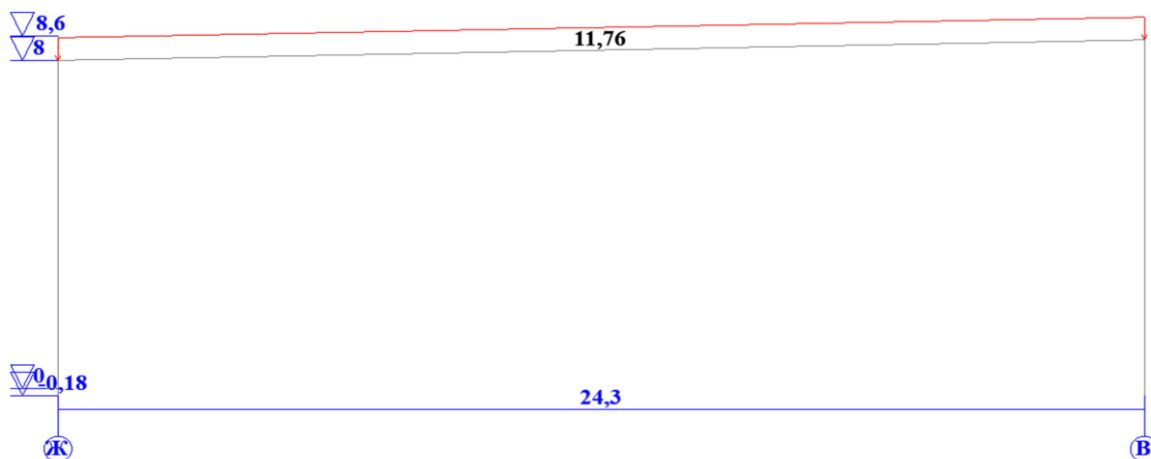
Завантаження поперечної рами будівлі сніговим навантаженням
